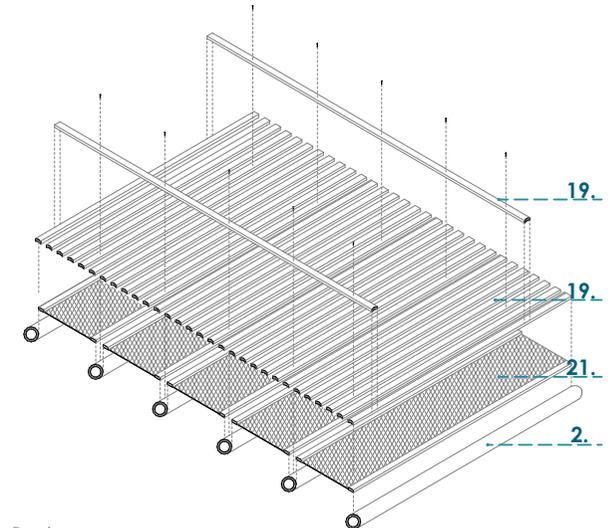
Detalle de cielos rasos con aislante acústico y sin aislante. Fuente: Elaboración Propia
